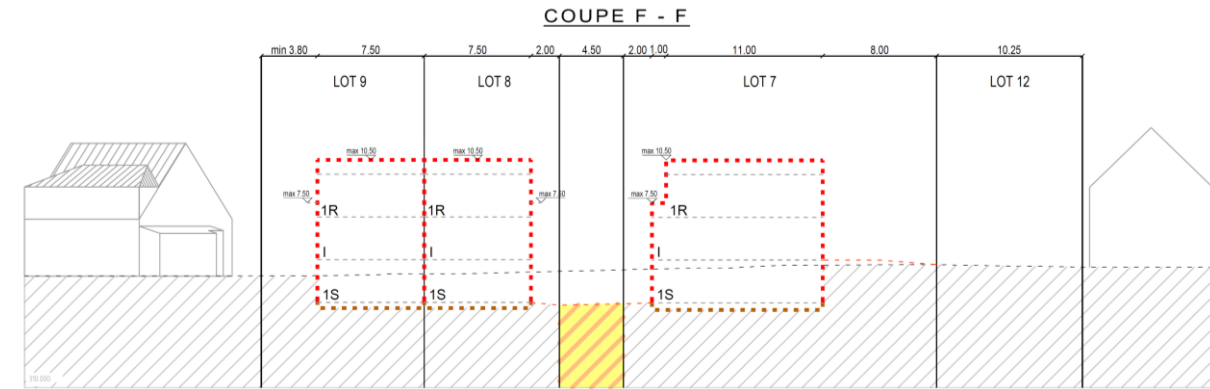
Coupes des constructions des lots 7 à 9 (Source : Best)
